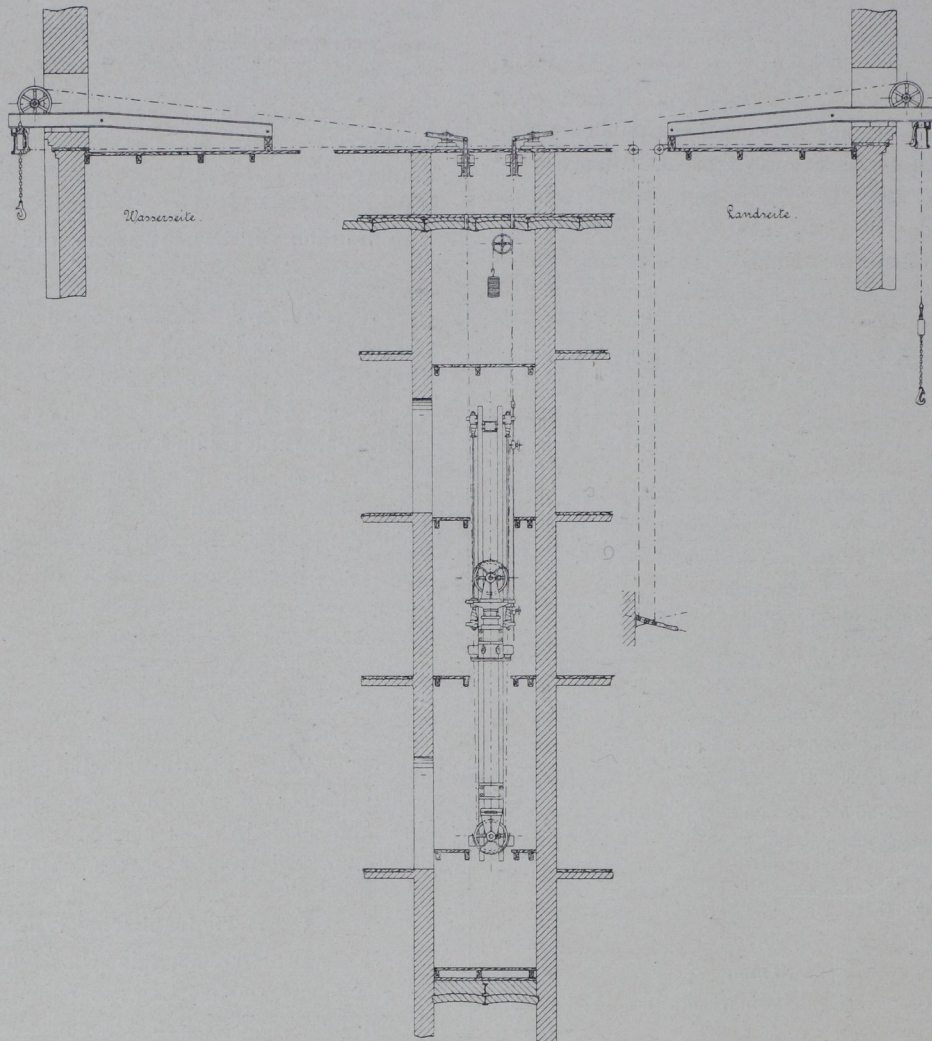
auf S. 126 zeigt zunächst die allgemeine Ausführung und Anordnung einer hydraulischen Winde mit einfachem Tauchkolben nach C. Hoppe in Berlin. Die Winde wird entweder schrägliegend im Dachgeschoss des Lagerspeichers oder auch wie in der Figur vertikal in einem besonderen Schacht aufgestellt; im letzteren Falle kann die Winde, da sie im abgeschlossenen Raum liegt, besser gegen Frost geschützt werden als im ersteren, wo einerseits bei eintretender Undichtheit oder
